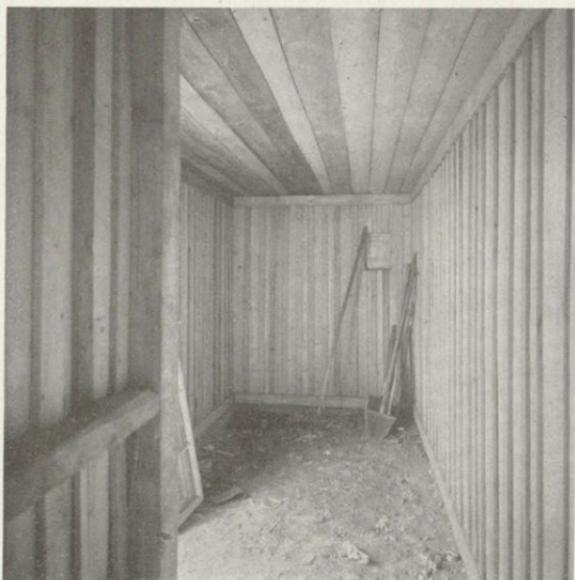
Stadtrandsiedlung Leopoldau-Wien: Innenansicht eines Siedlerhauses vor der Fertigstellung; Blick in den Kleintierstall, links Trockenklosett
